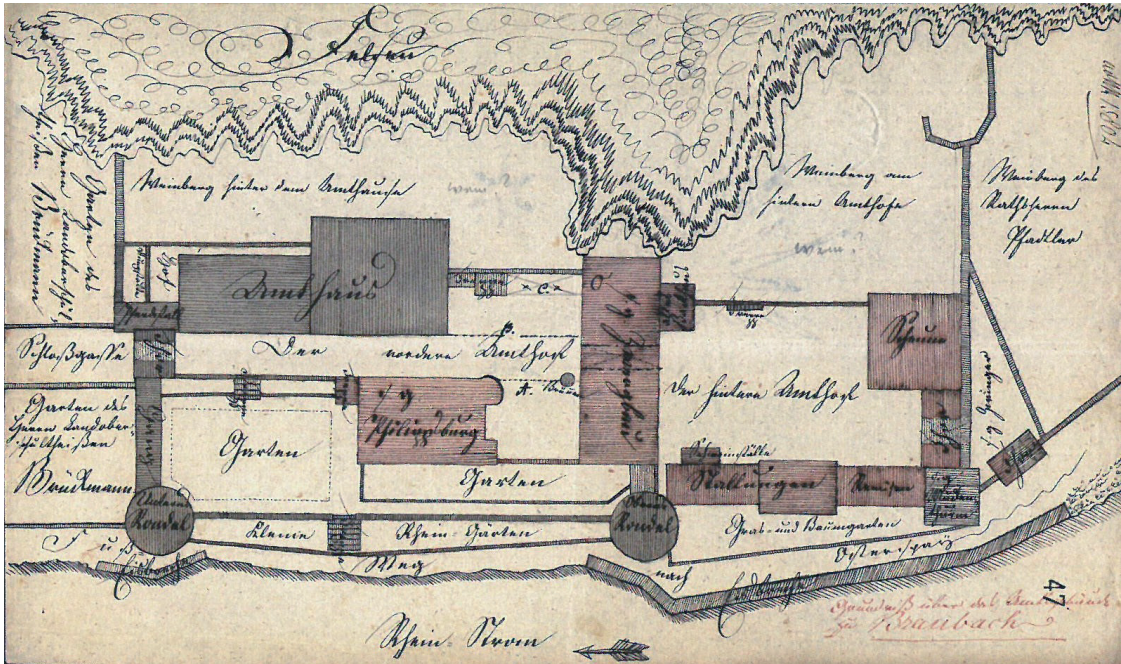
Grundriss der Philippsburg zu Braubach, kolorierte Federzeichnung um 1820 (HHStAW Abt. 212, Nr. 174). Die Datierung der Zeichnung ergibt sich aus dem Fehlen des bereits niedergelegten Verbindungsbaues zwischen Hauptgebäude und Küchenbau.
